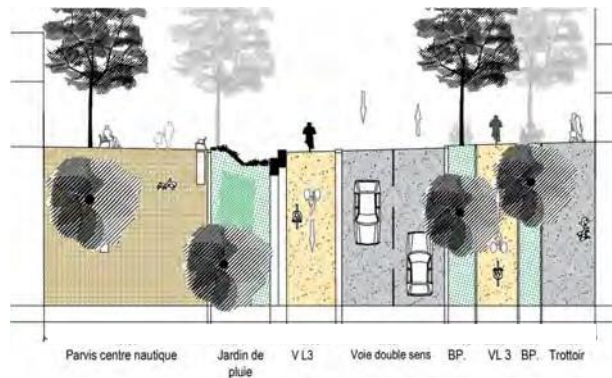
A gauche : Profil en travers type Av Edmond Locard, section centrale, phase AVP : Echelle 1/200^{ème}. Sources : Ingerop/Ilex (2022).
